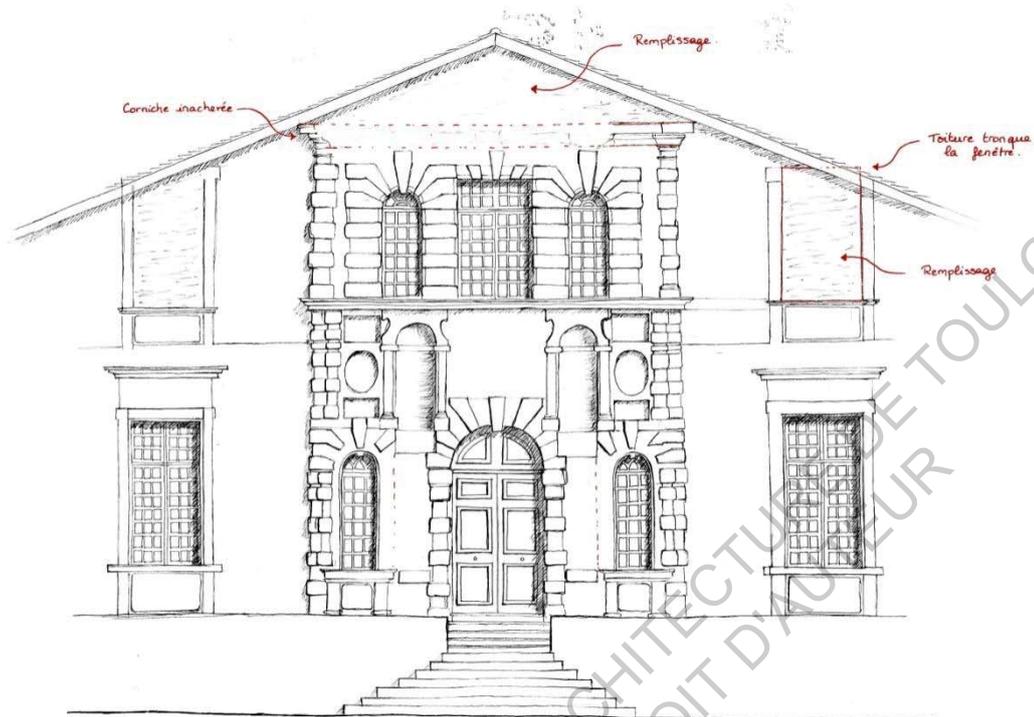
Conséquences de la pose de la toiture à deux pentes sur la façade Sud.
